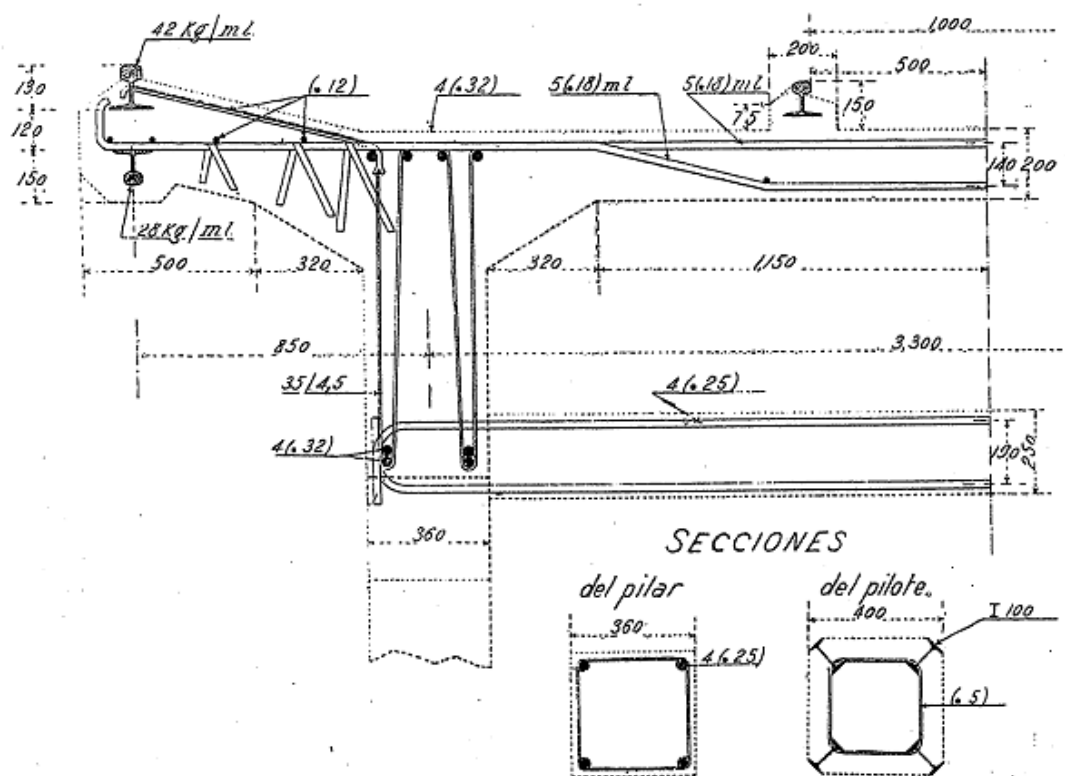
Secciones transversales de las piezas que forman la estructura del embarcadero (Zafra, 1910).
